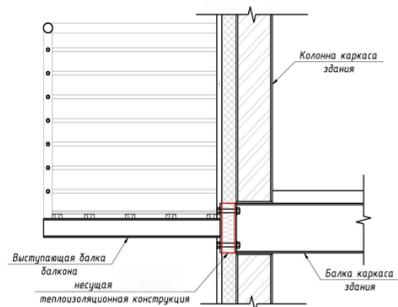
Выступающая балка балкона отсечен от теплового контура здания с помощью теплоизоляционного несущего элемента.
